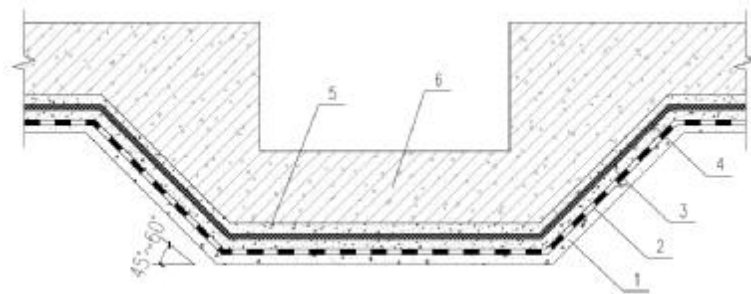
基础底板不等高处隔振垫层施工构造图
